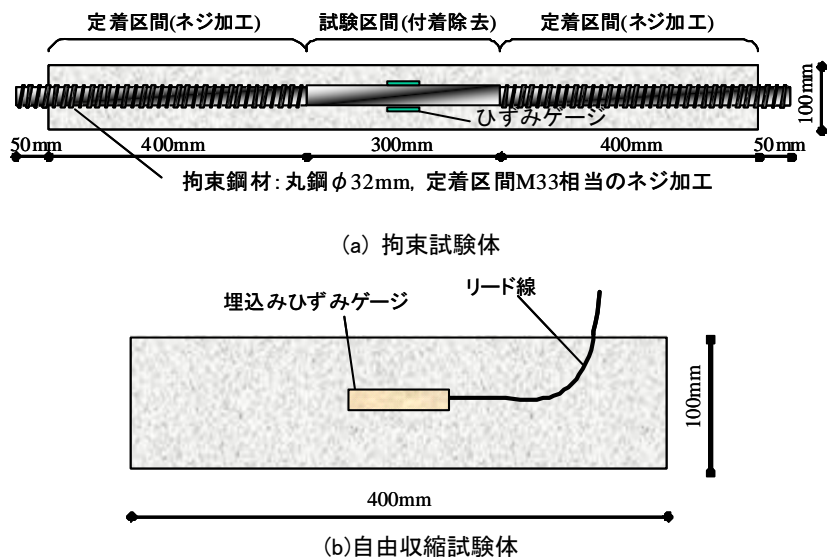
収縮ひび割れ評価試験の試験体概要
